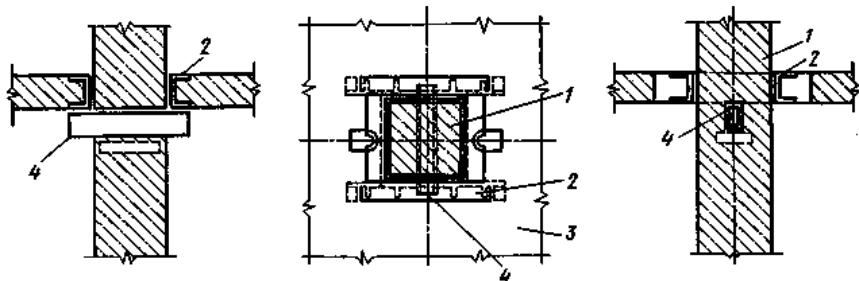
Узел крепления плит перекрытий к колоннам:
